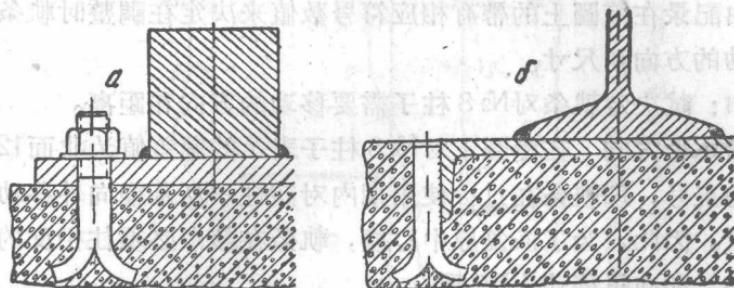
軌條與鋼筋混凝土梁的死連接的類型
